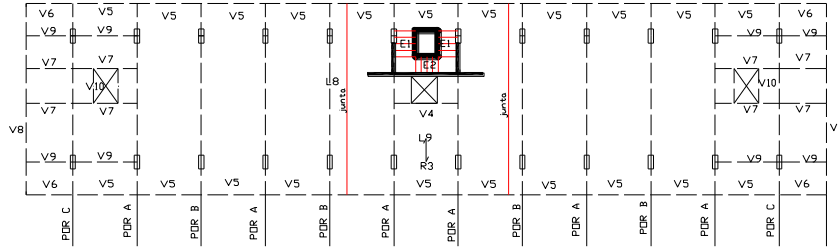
Planta estrutural do piso de entrada (R/C) [40].
